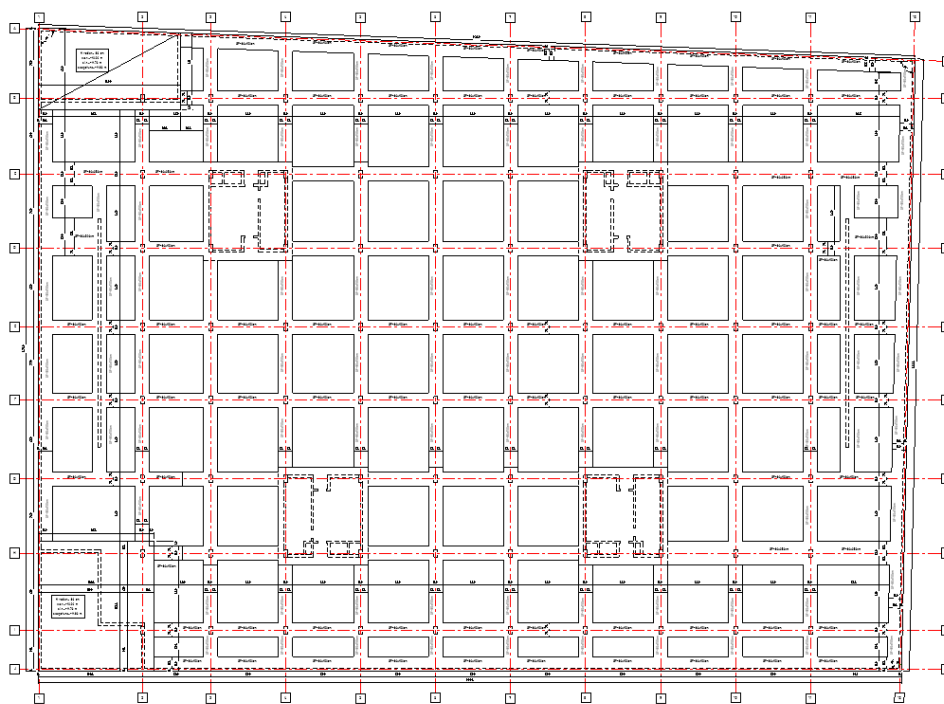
Plan cofraj fundații (Scenariul 2 – Sistem de fundare parcare)
